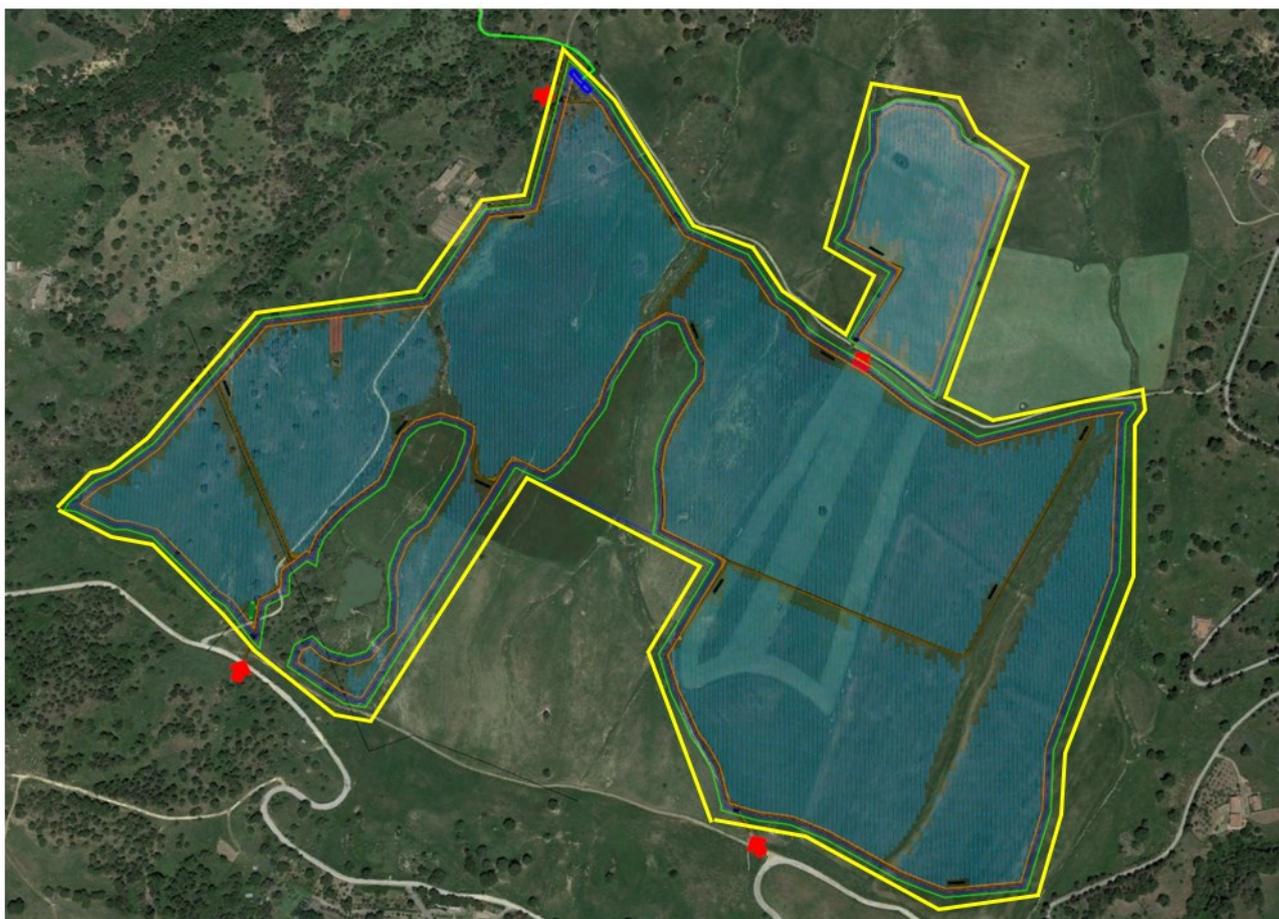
opera di mitigazione sul perimetro dell'impianto
